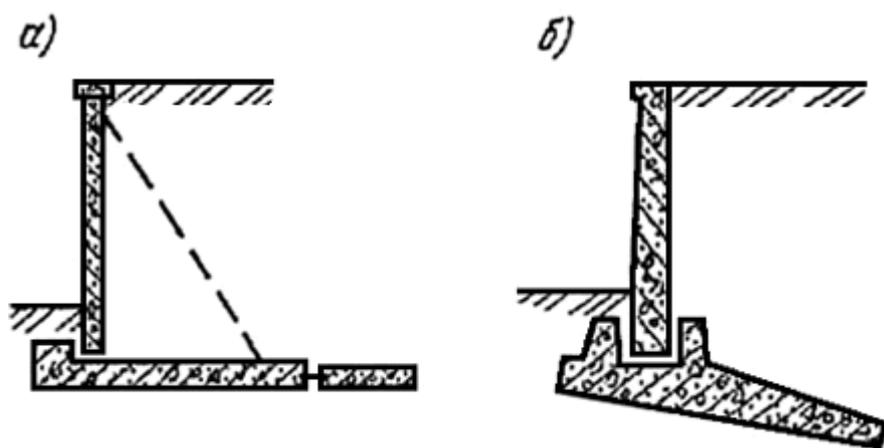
Сборные подпорные стены: а — с анкерной плитой; б — с наклонной подошвой
